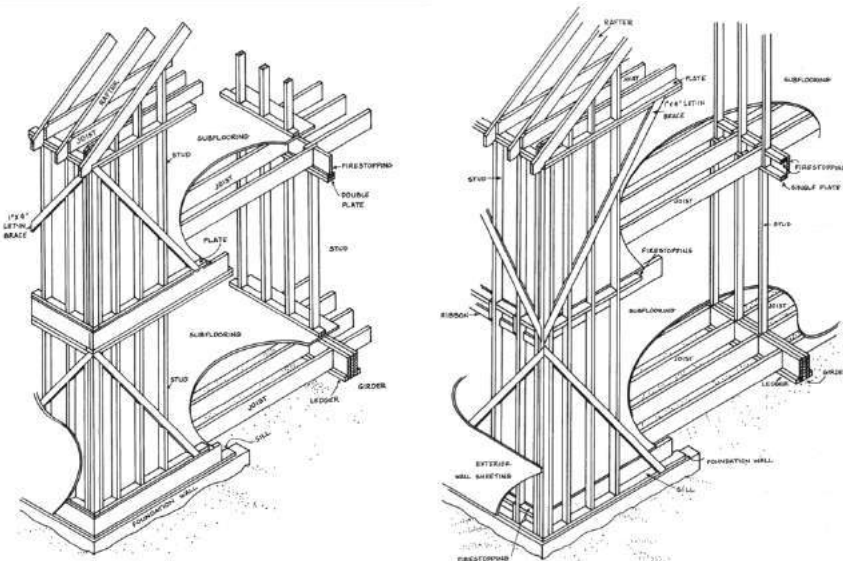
Detalle constructivo de entramado ligero de madera comúnmente utilizados en Norteamérica y Japón. A_ Sistema constructivo Platform Frame. B_ Sistema Balloon Frame.
